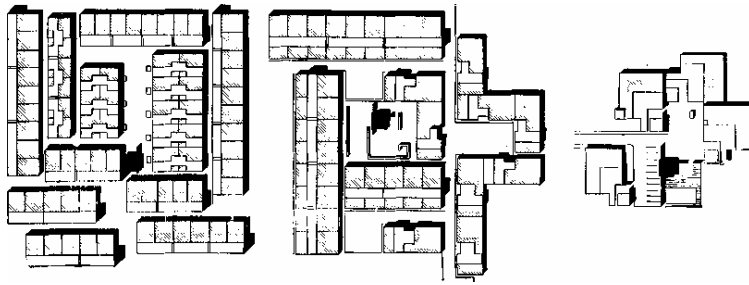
Касадо (Мавританія) — варіанти планування житлових груп
